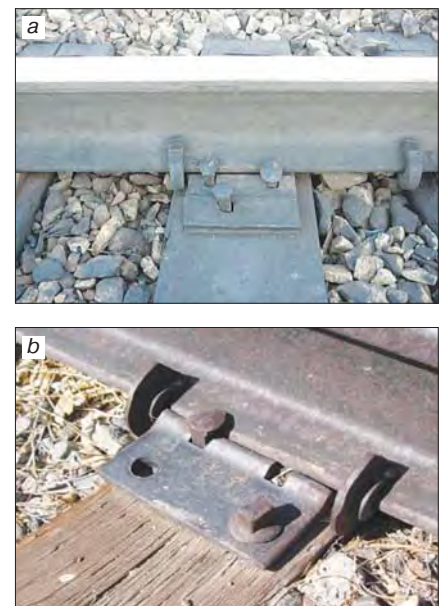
Общий вид промежуточных рельсовых креплений смешанного типа в ж/д пути на деревянных шпалах [106]: *a* – костыльное; *b* – шурупно-костыльное
